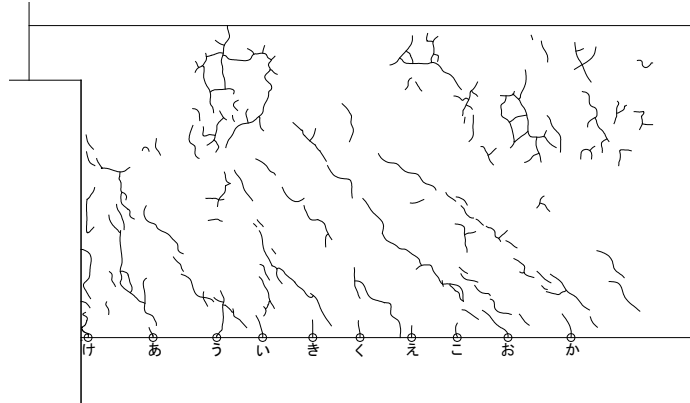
基礎梁ひび割れ幅測定位置(試験体 A-7b 正載荷)
